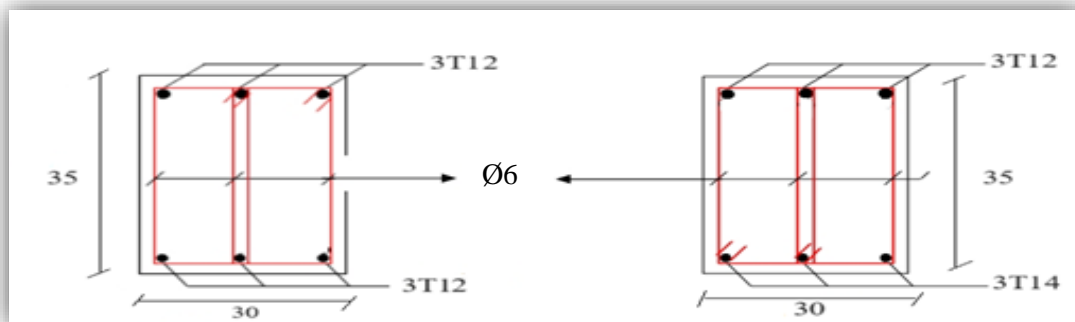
Schéma de ferrailage des poutres secondaire de rive (Etage et Terrasse).
